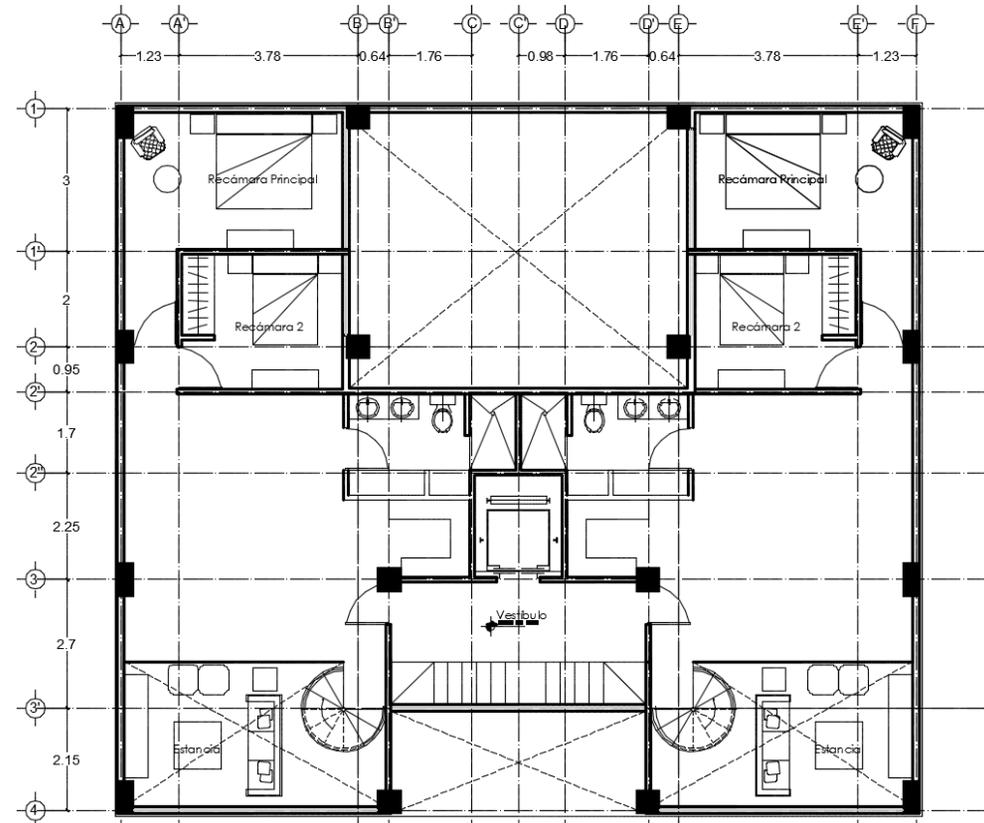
Planta tipo C. Penthouse- planta alta, sexta hipótesis
